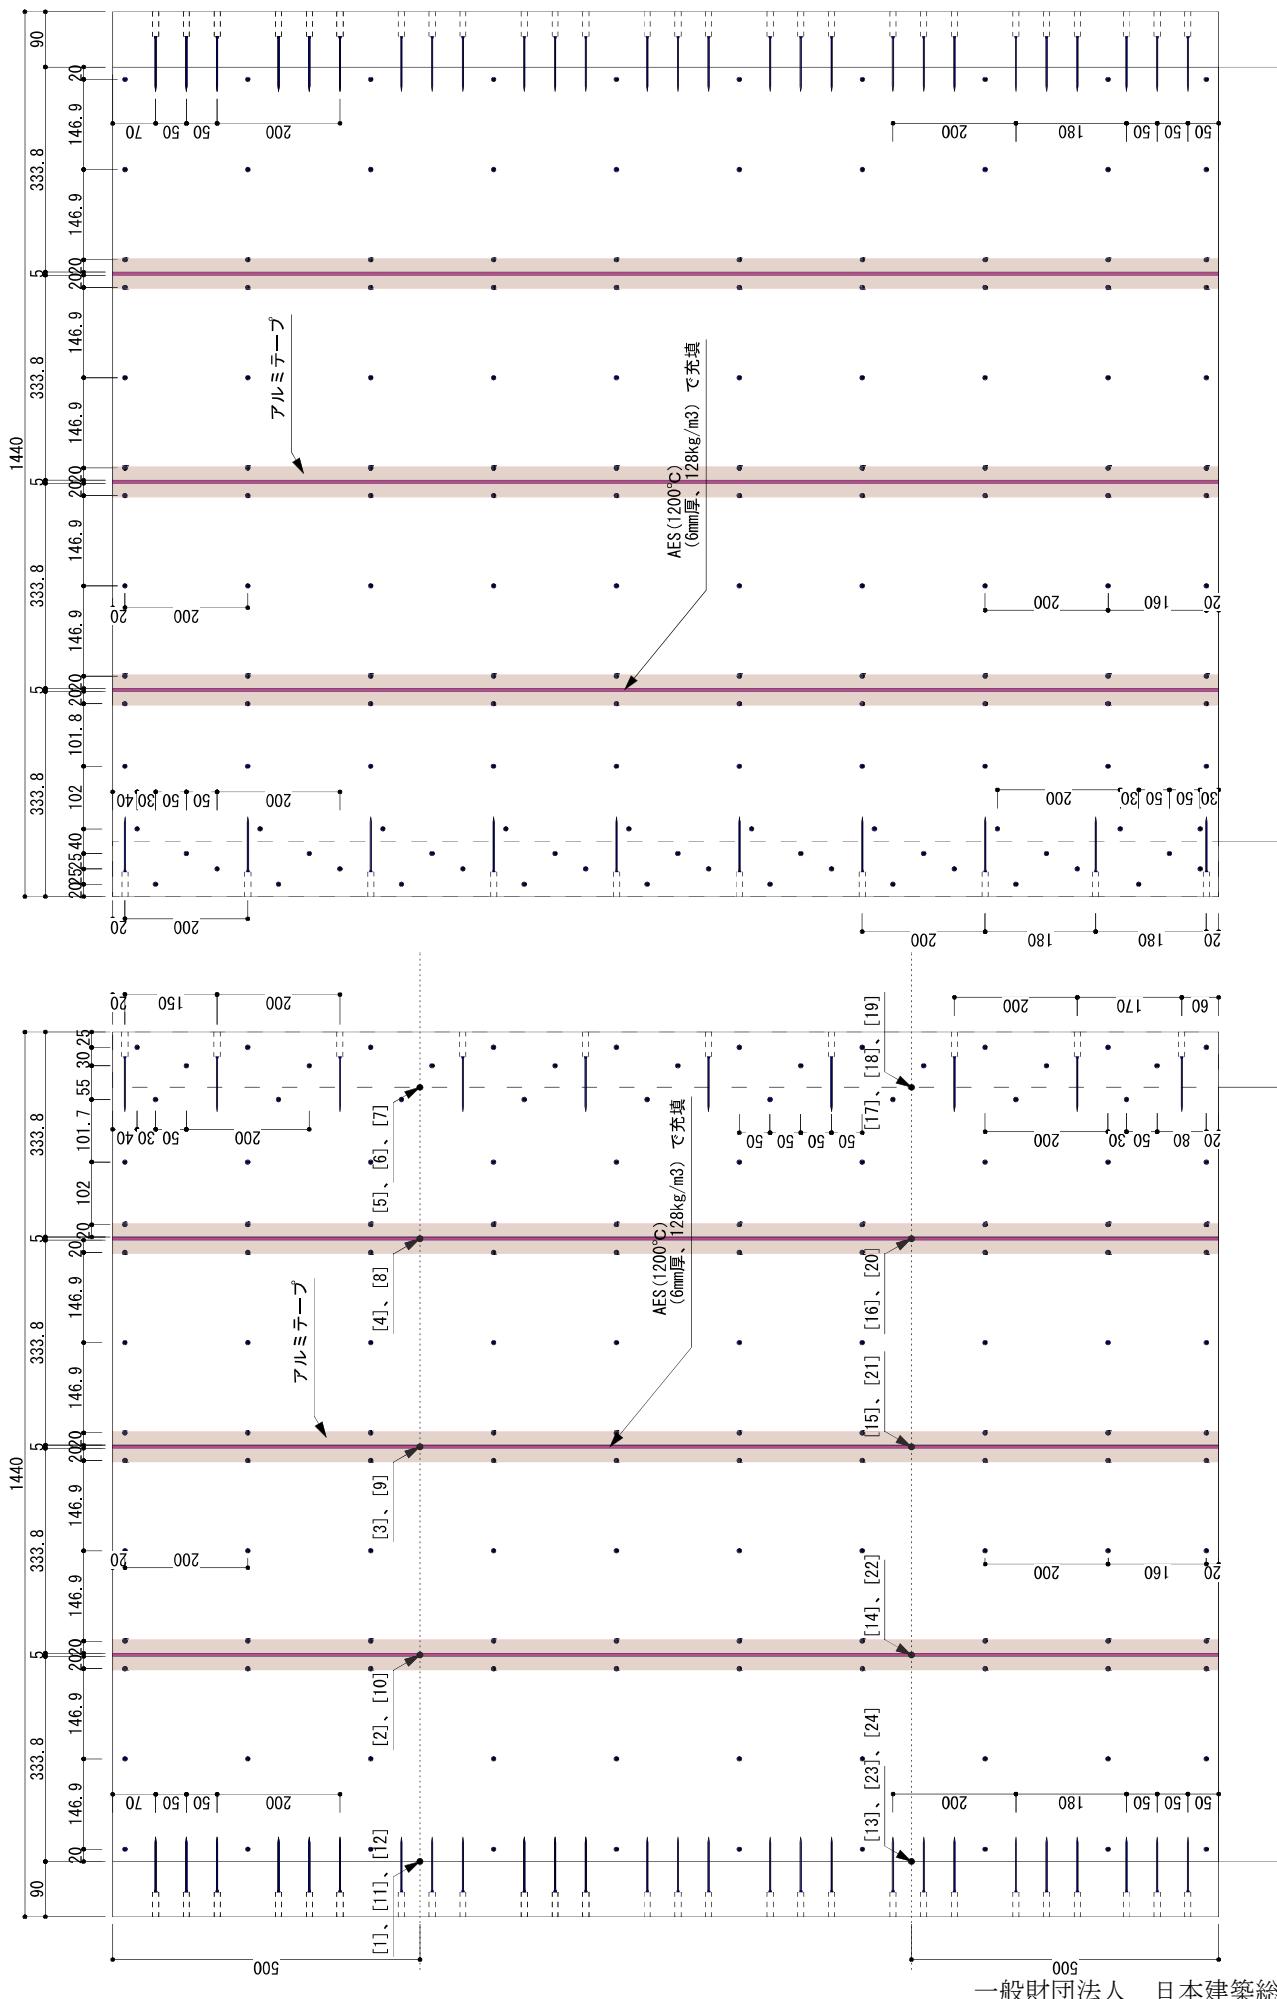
試験体の構造・寸法・内部温度測定位置（寸法単位：mm）
